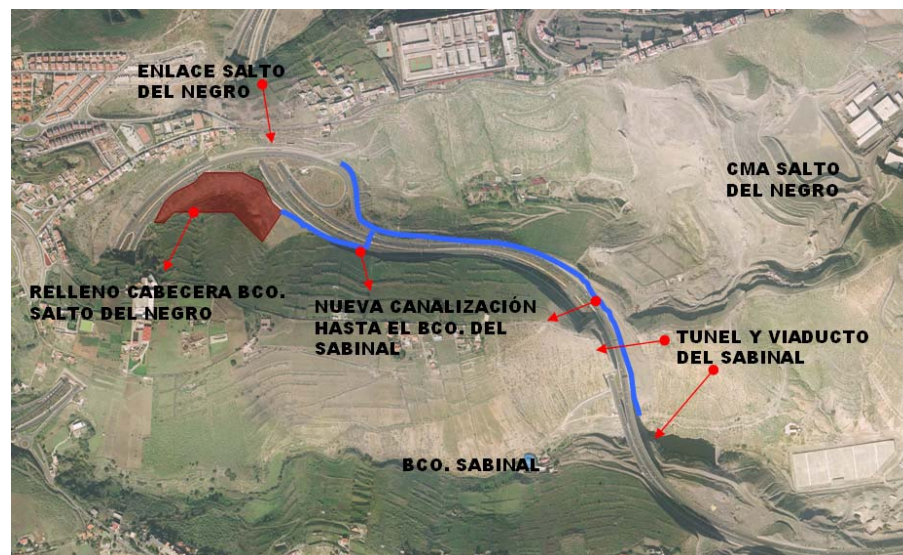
Conducción de las aguas de lluvia hacia el Bco. del Sabinal.
